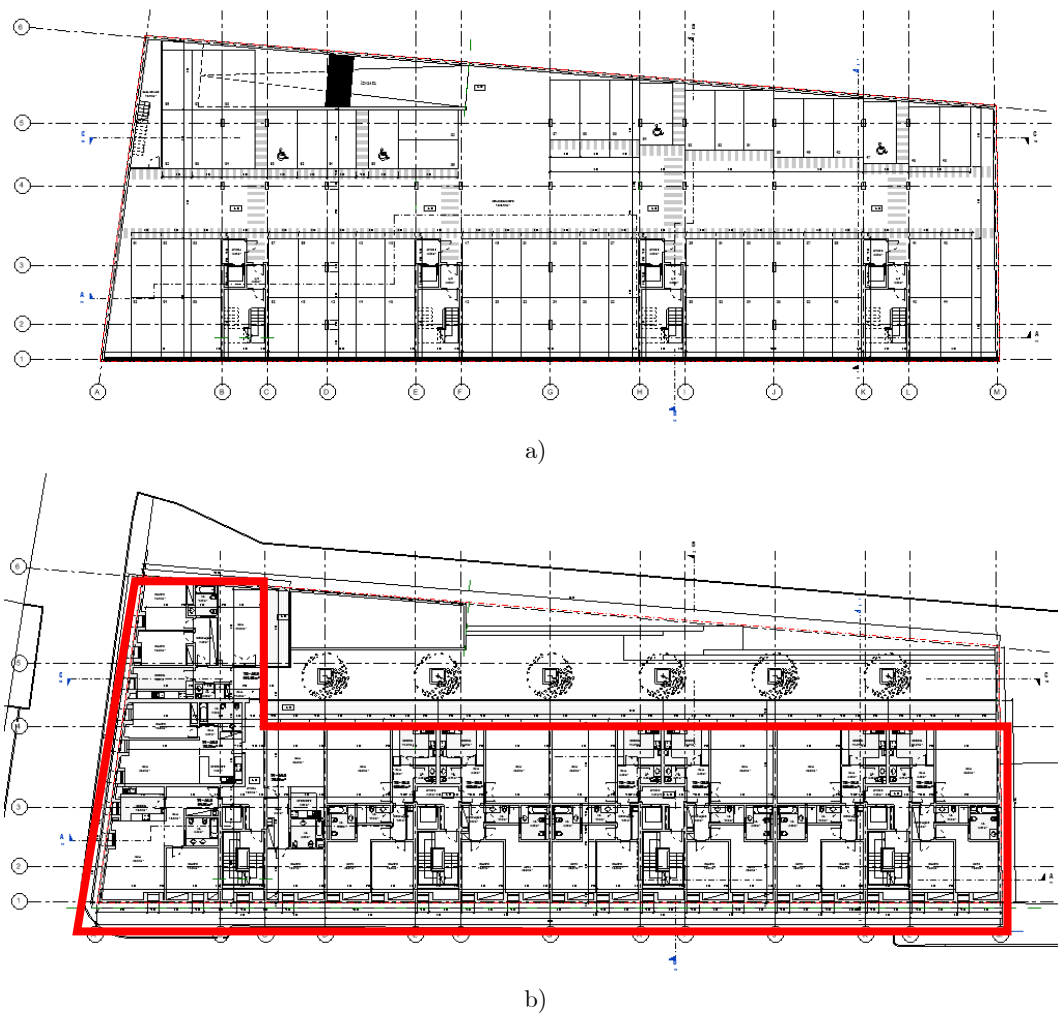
Plantas de arquitetura: a) piso -1; b) pisos 1 e 2.
